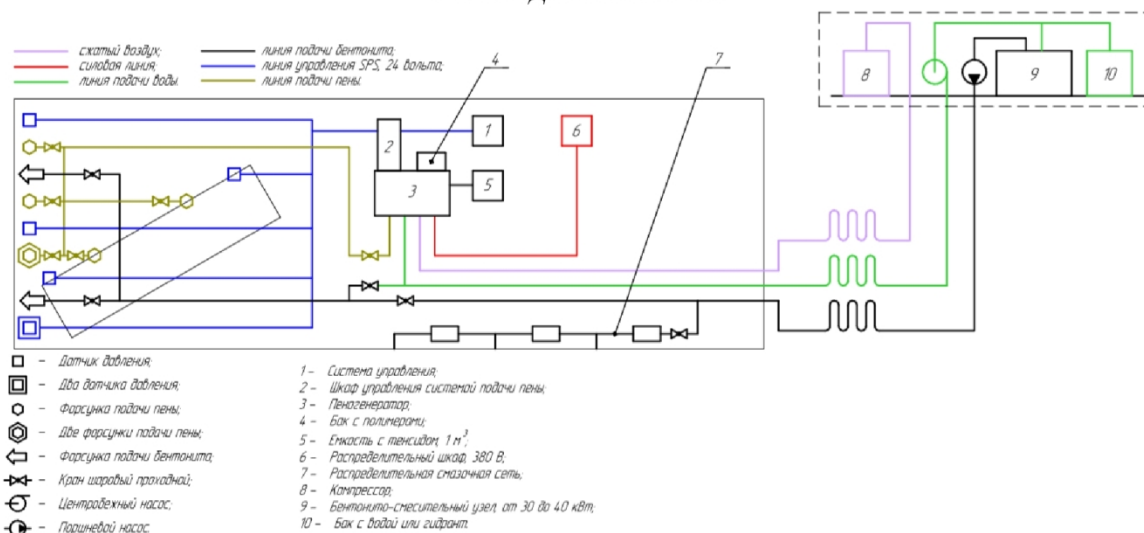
Схема контроля грунтопригруза и кондиционирования грунта прямоугольного щита размером 4х4м.
